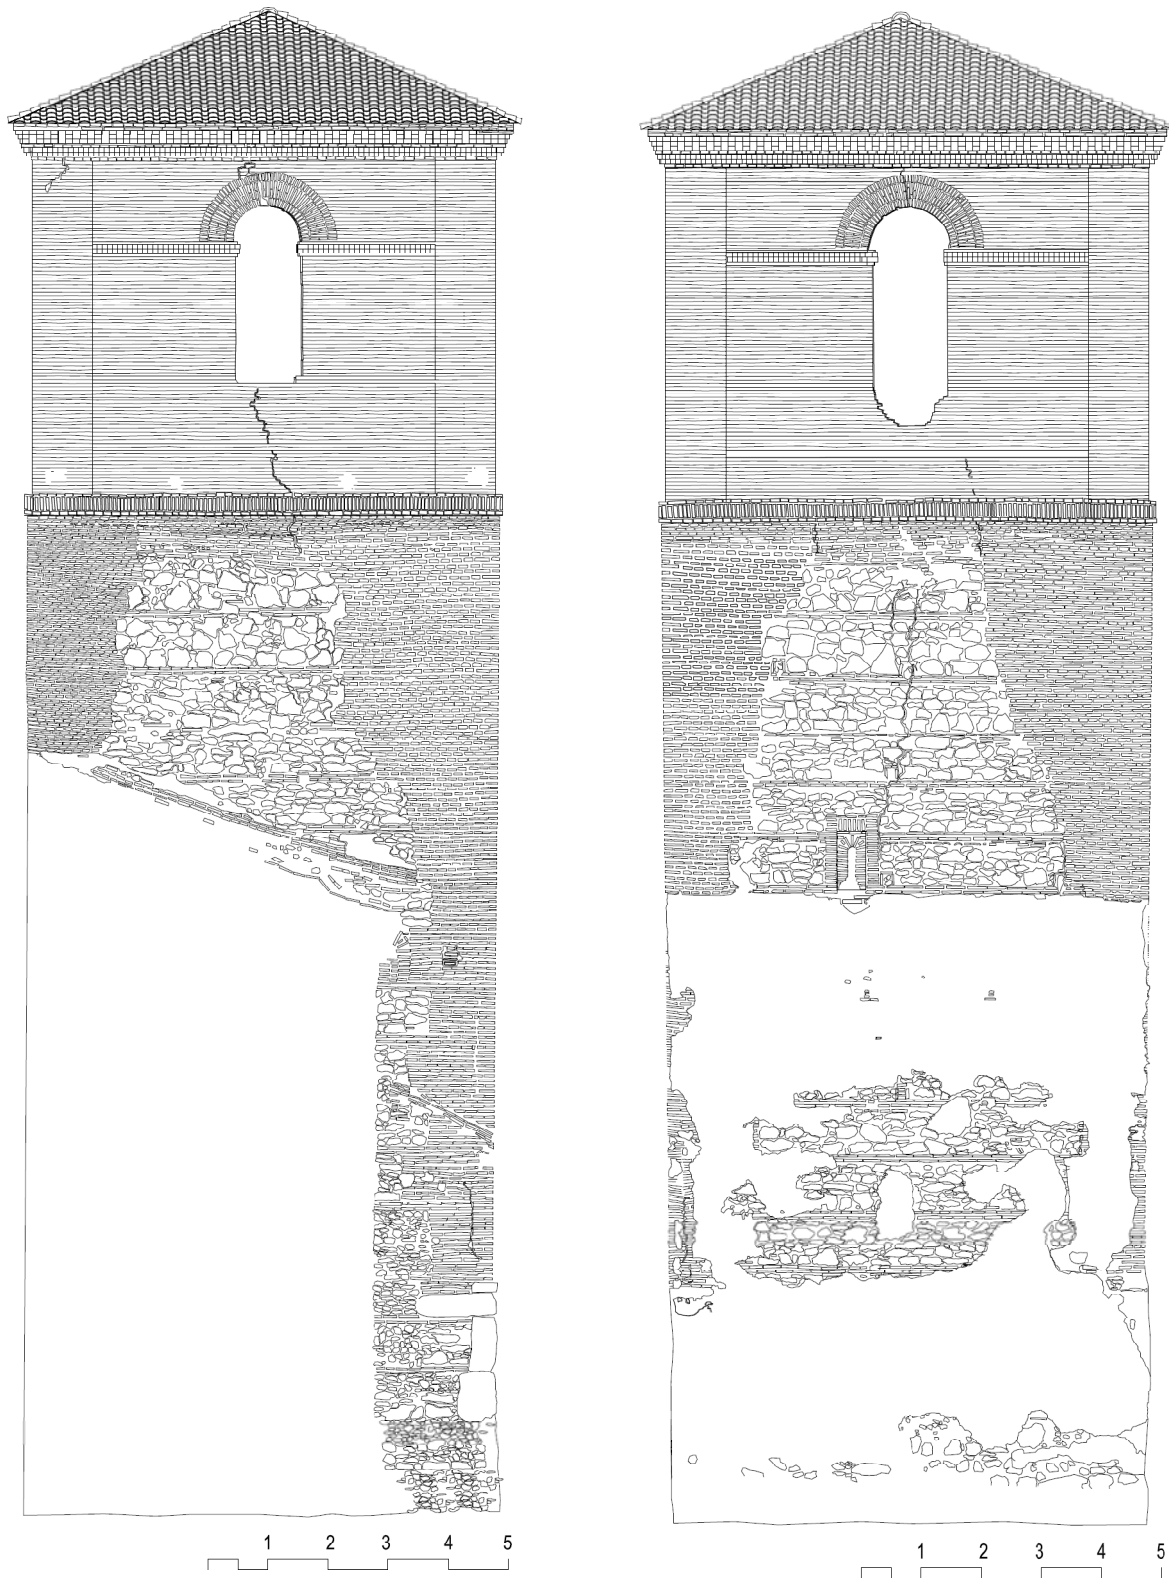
alzados oeste y sur de la torre de la iglesia parroquial de Sinlabajos. Estado actual.
